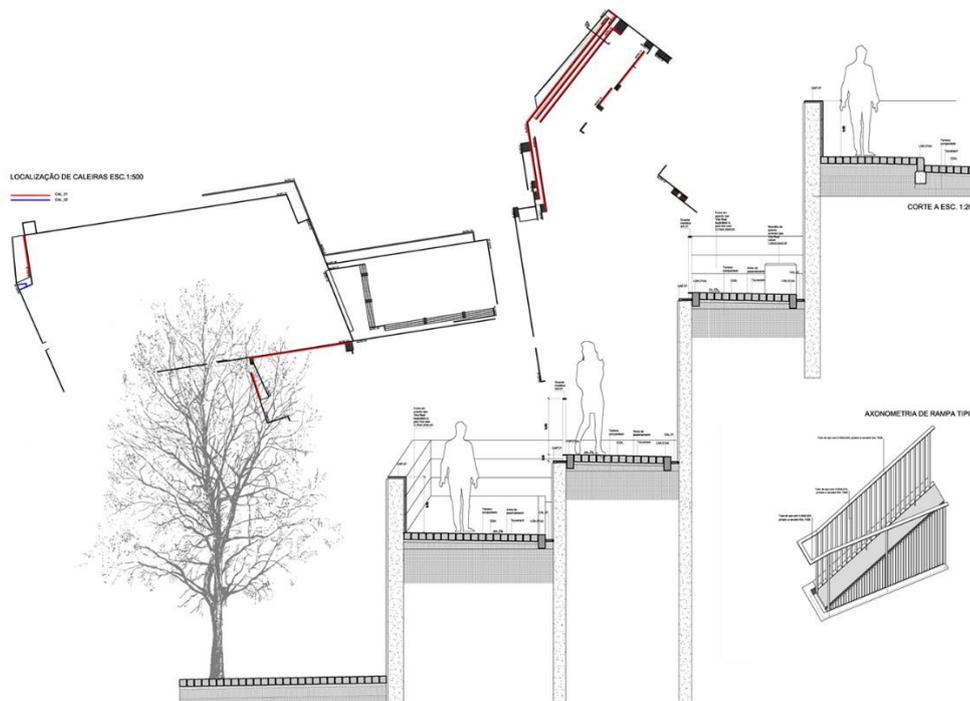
Corte construtivo da rampa que liga alameda arquiteto Carlos Ramos à rua Diogo Macedo,
